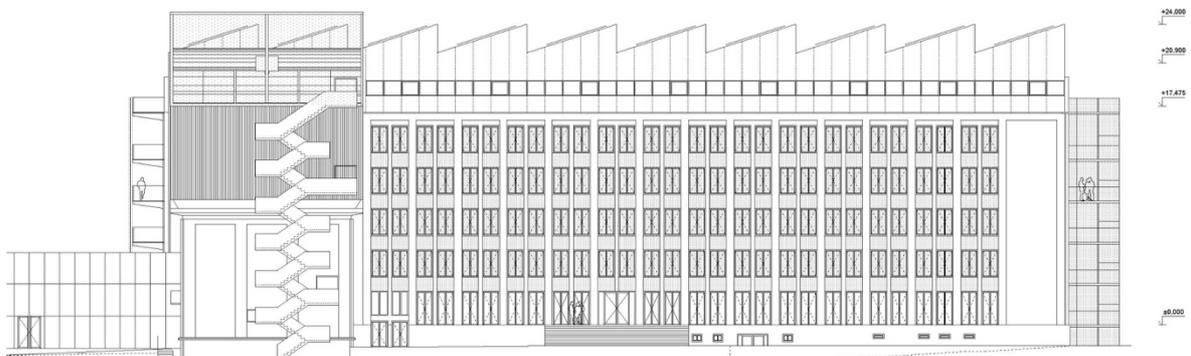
Nord-West-Ansicht (Straße) – neue Planung. Autoren: PLURAL
